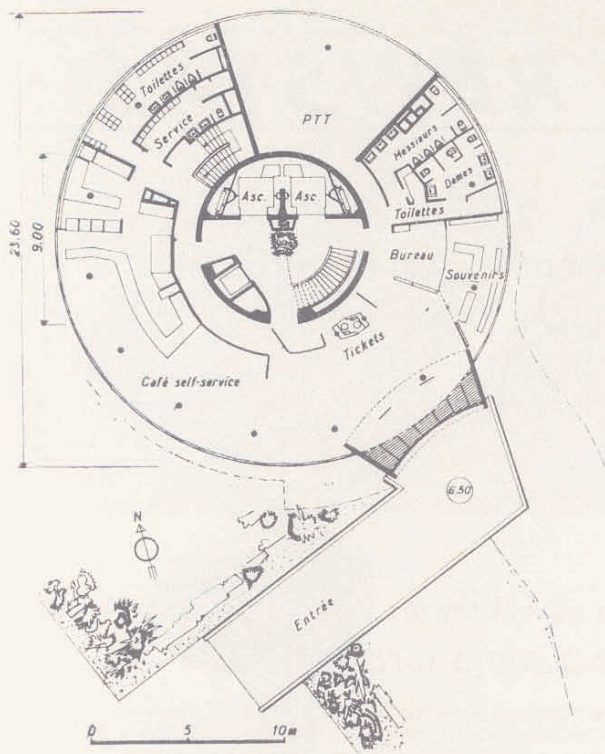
ª — Plano de la planta baja (cota 6,50).
